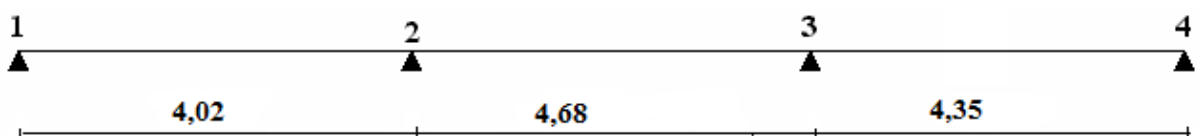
Schéma statique de la poutrelle à trois travées
